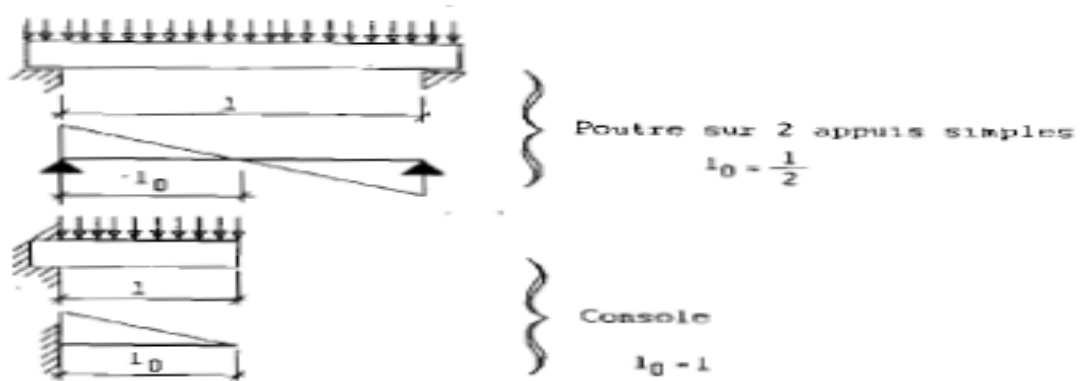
Distance  $l_0$  pour le cas d'une poutre simplement appuyée et le cas d'une console [1]
